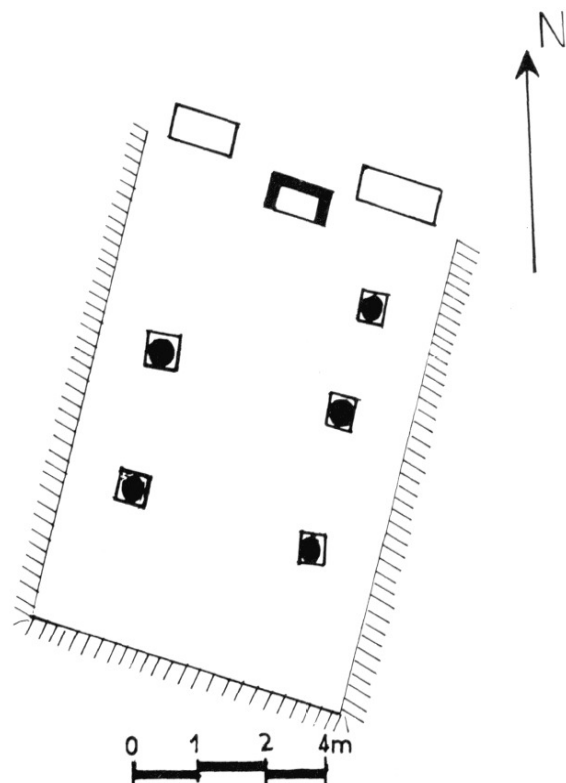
Le sanctuaire rural de Bekkouch (n° 180); croquis de la ruine.
